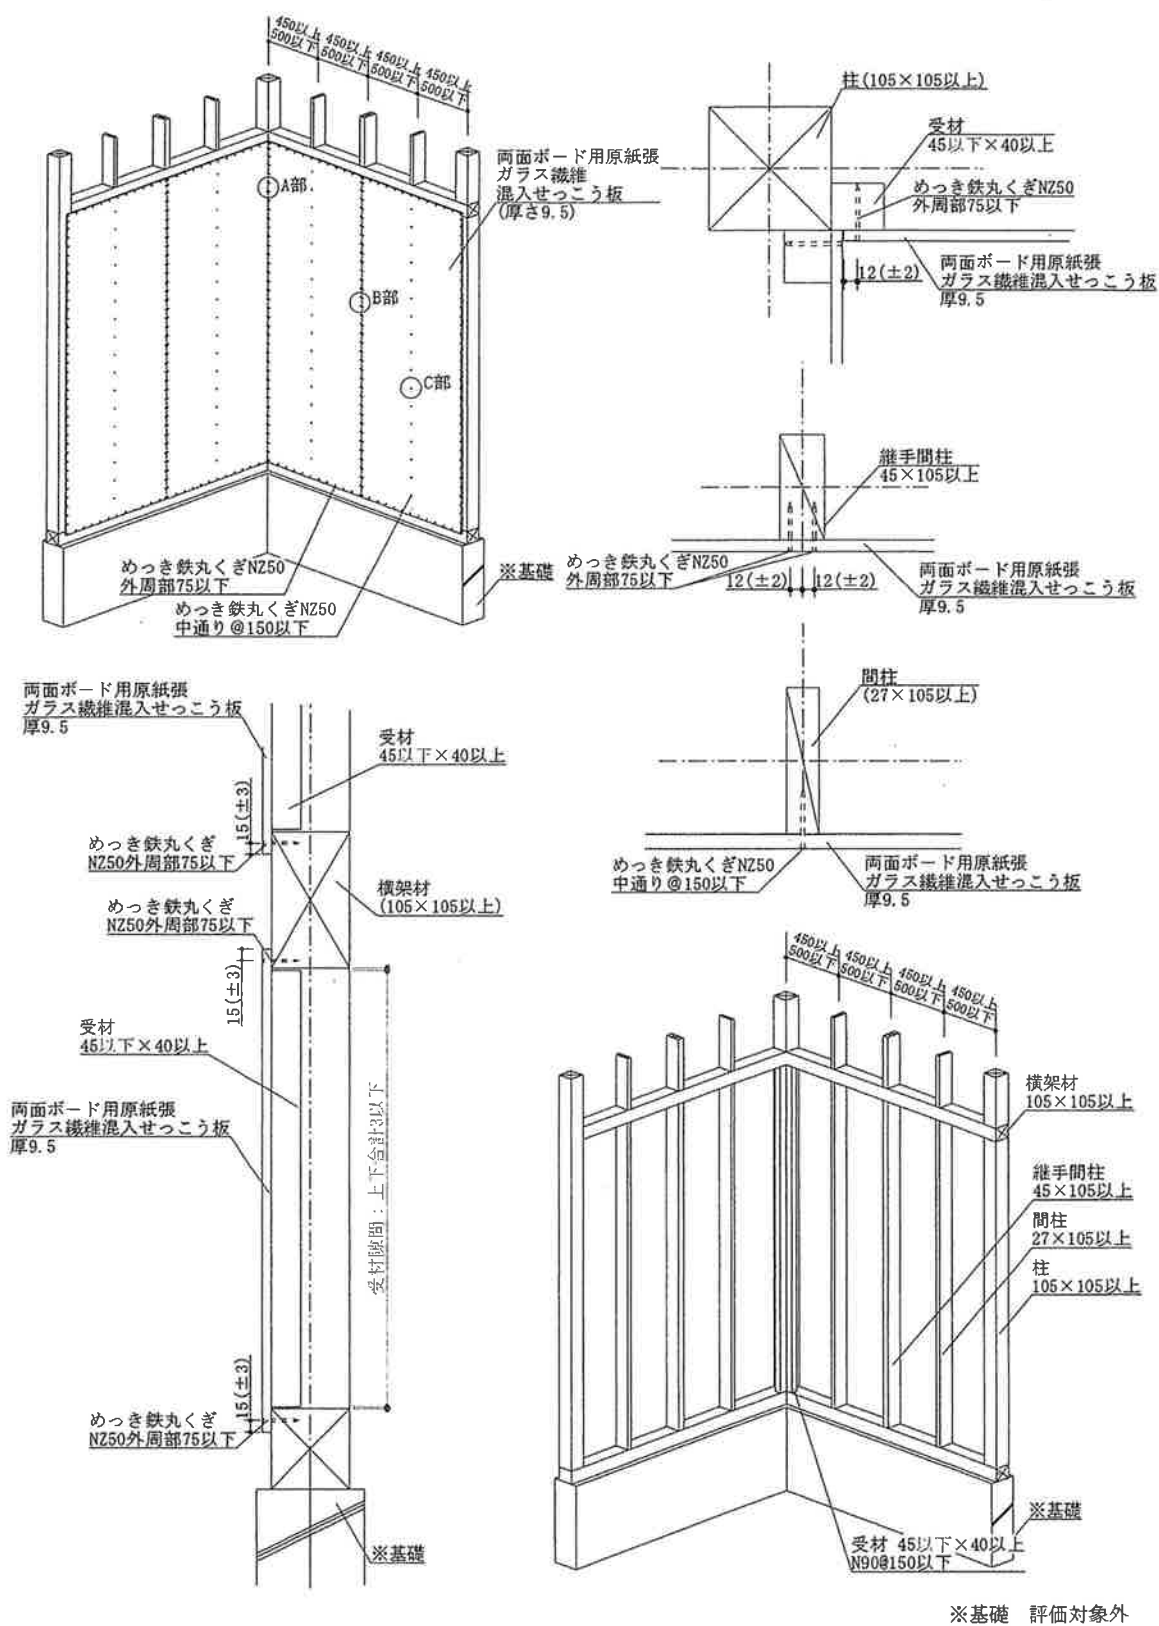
施工詳細図：1枚張りの場合 (寸法単位：mm)
